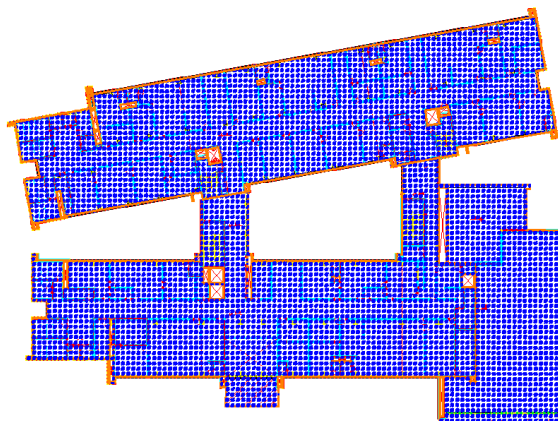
Área considerada para pavimento tipo (2º Pavimento)
